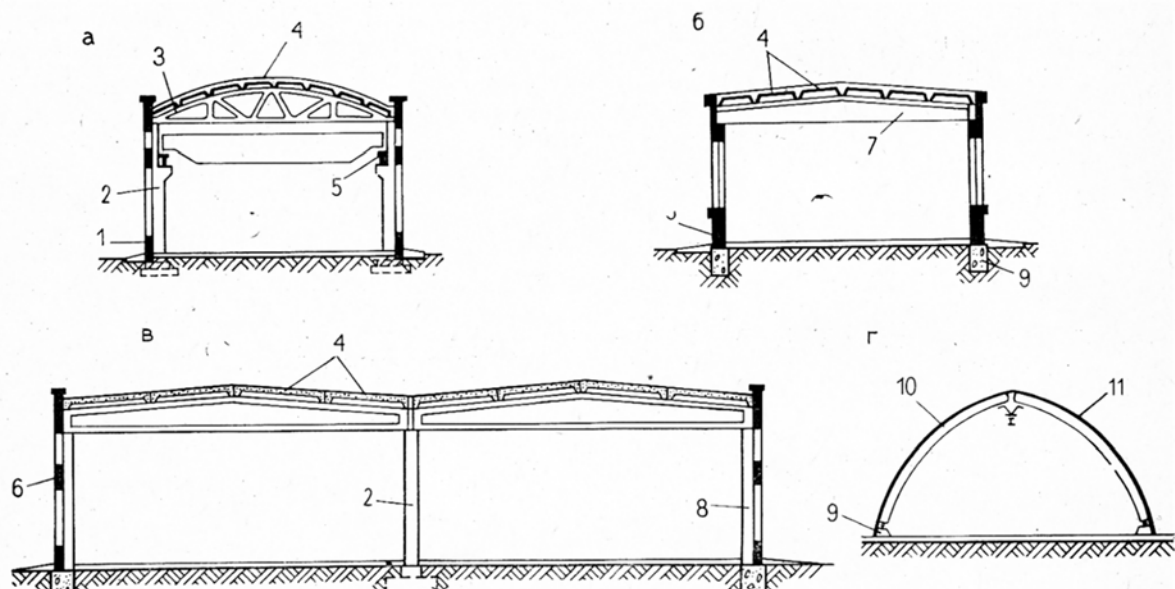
Конструктивные типы одноэтажных промышленных зданий [38]:
